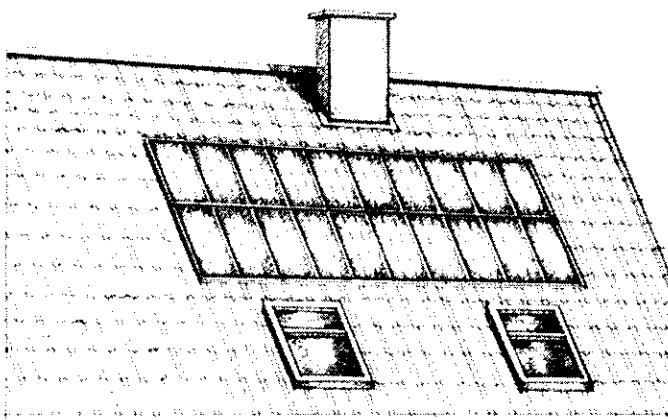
Фотоэлектрические коллекторы на черепичной кровле жилого здания
